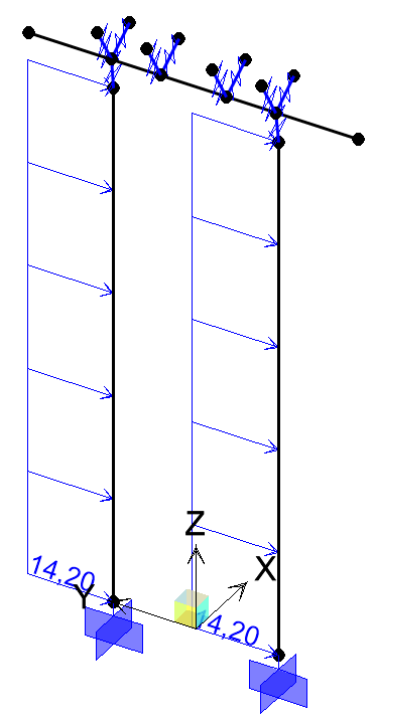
Cargas do Macaco para Elevação da Superestrutura
